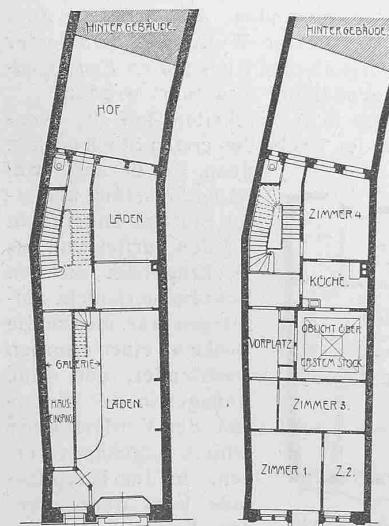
Wohn- u. Geschäftshaus K. J. Wyss. Grundrisse vom Erdgeschoß und II. Stock. Masstab 1:400.
